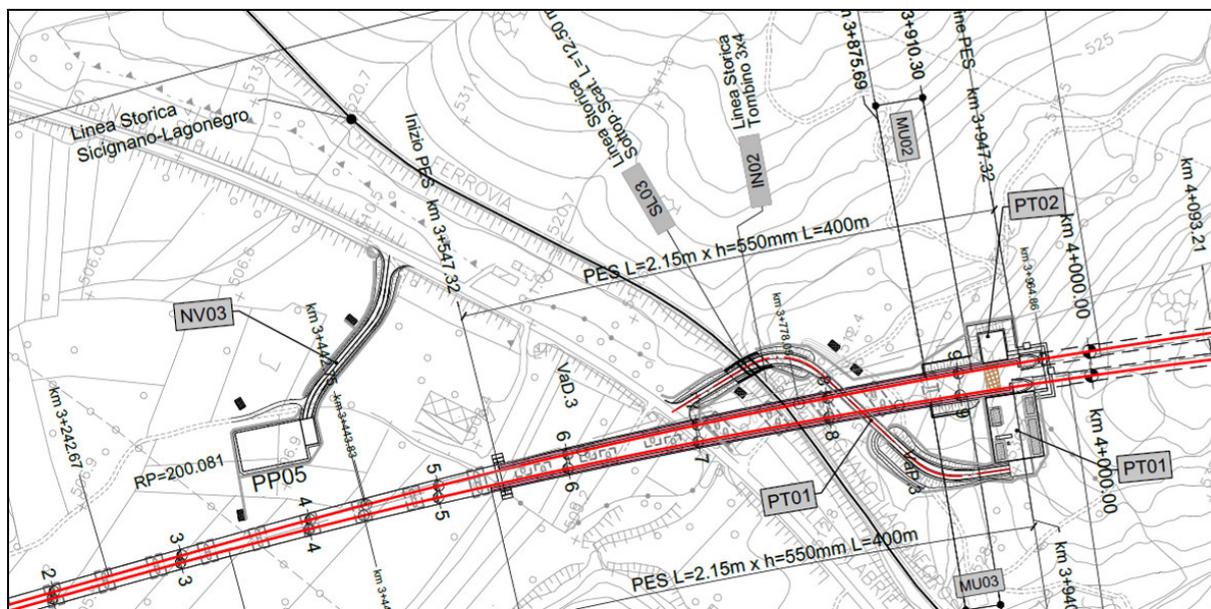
Planimetria con individuazione della nuova viabilità NV33
